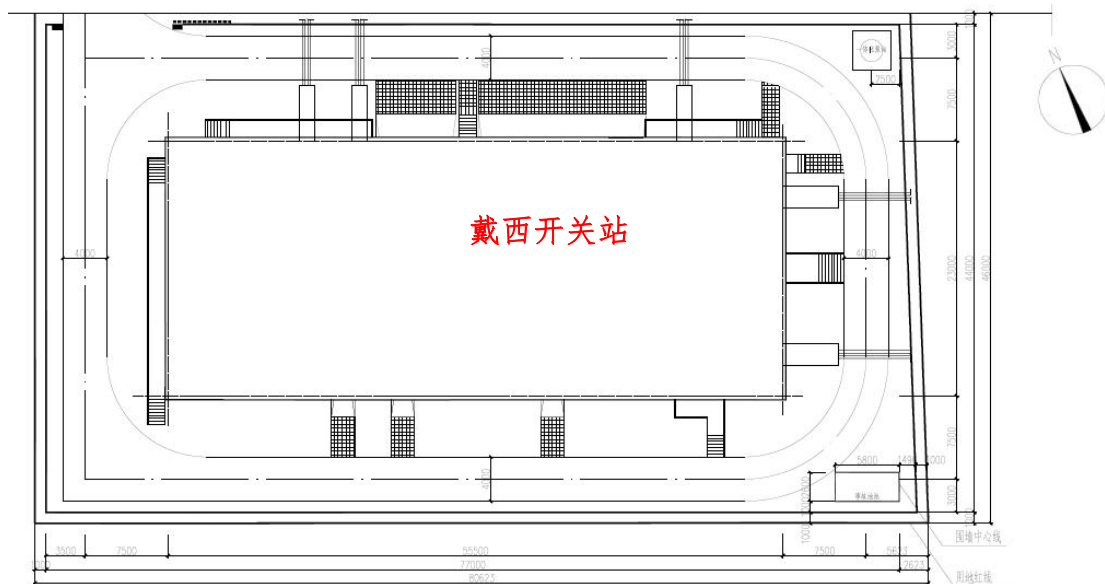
本期南京戴西 110 千伏开关站新建工程总平面示意图
